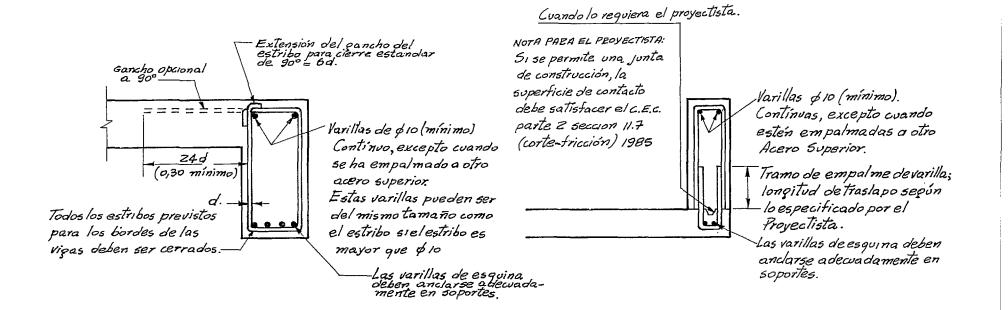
DETALLES DE CONSTRUCCION EN CONEXIONES
